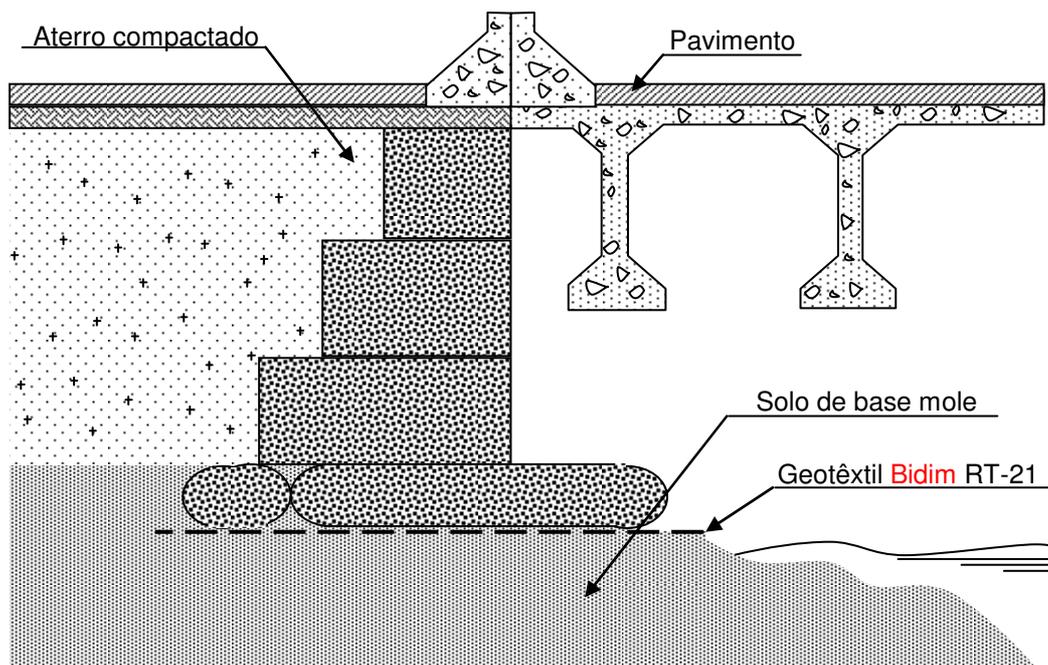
Detalhe de uma seção típica onde se empregou o muro de gabião.
